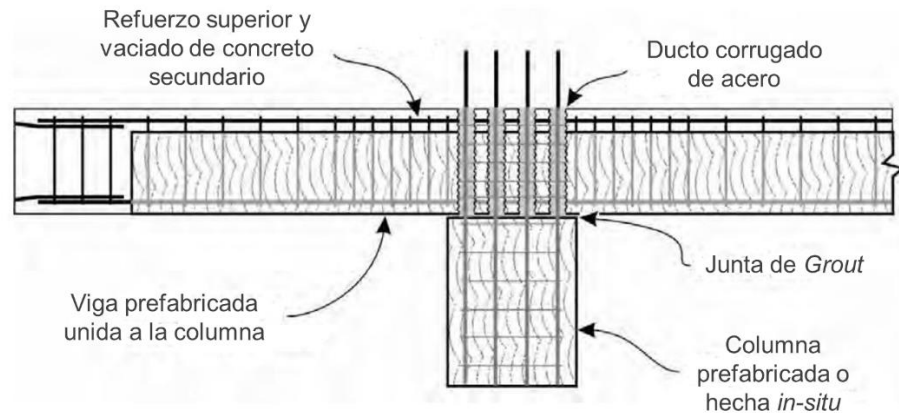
Conexión húmeda. Representación de la conexión de columnas y vigas prefabricadas. Adaptado de (FIB, 2003)
